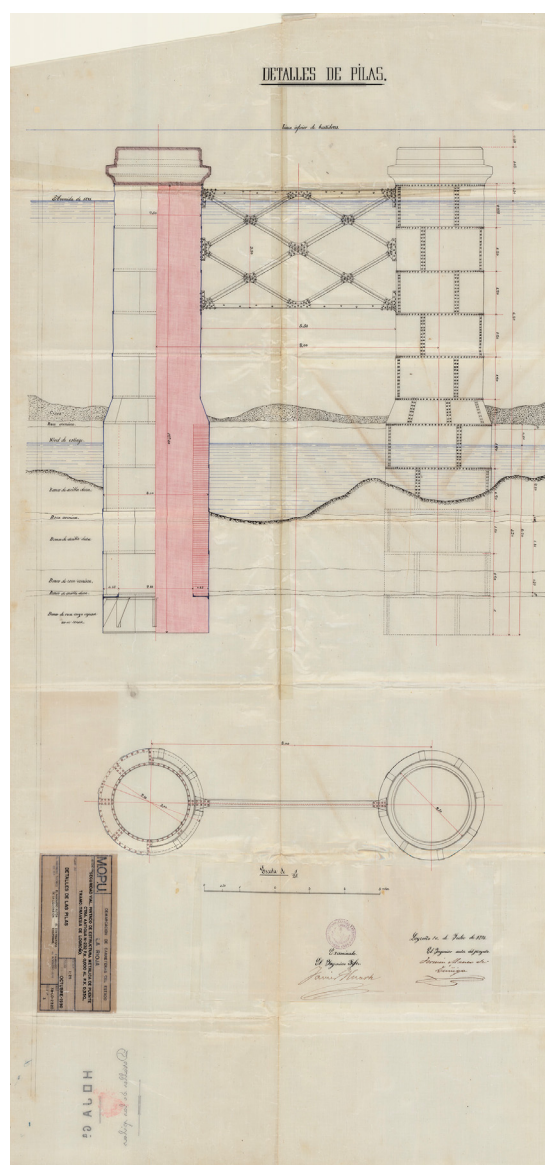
Plano de detalle de las pilas del puente de hierro sobre el río Ebro en Logroño, 10 de julio de 1881. Proyecto de FERMÍN MANSO DE ZÚÑIGA. AHPLR, OP-C-240/03.
